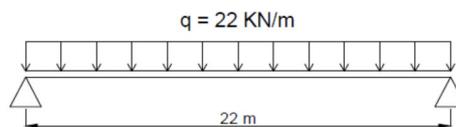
Viga teórica para el cálculo de una viga Tensairity®
